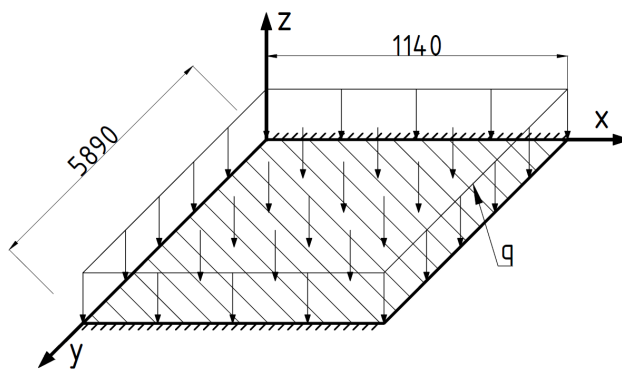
Схемы плит перекрытия из ДПК
